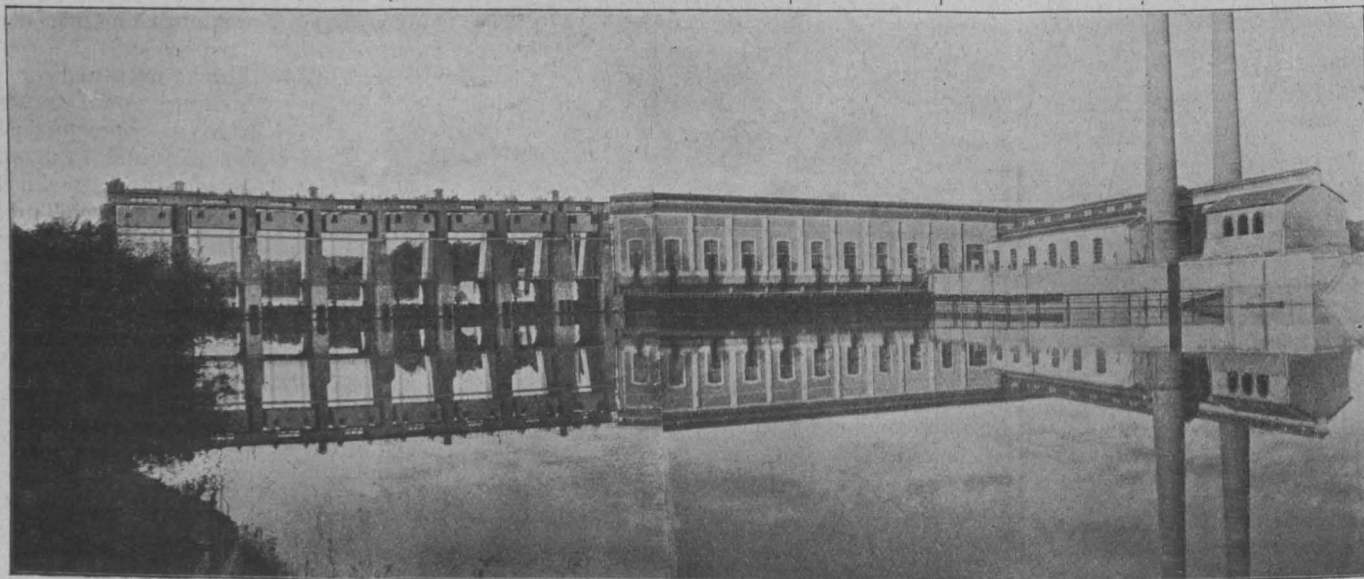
Tuilière, Gesamtansicht vom Oberwasser aus
